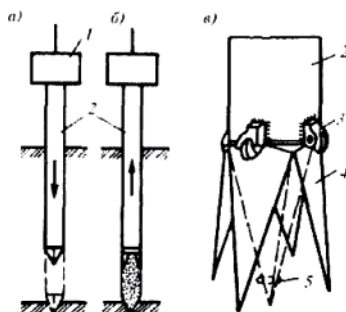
Схема устройства песчаных (грунтовых) набивных свай:
